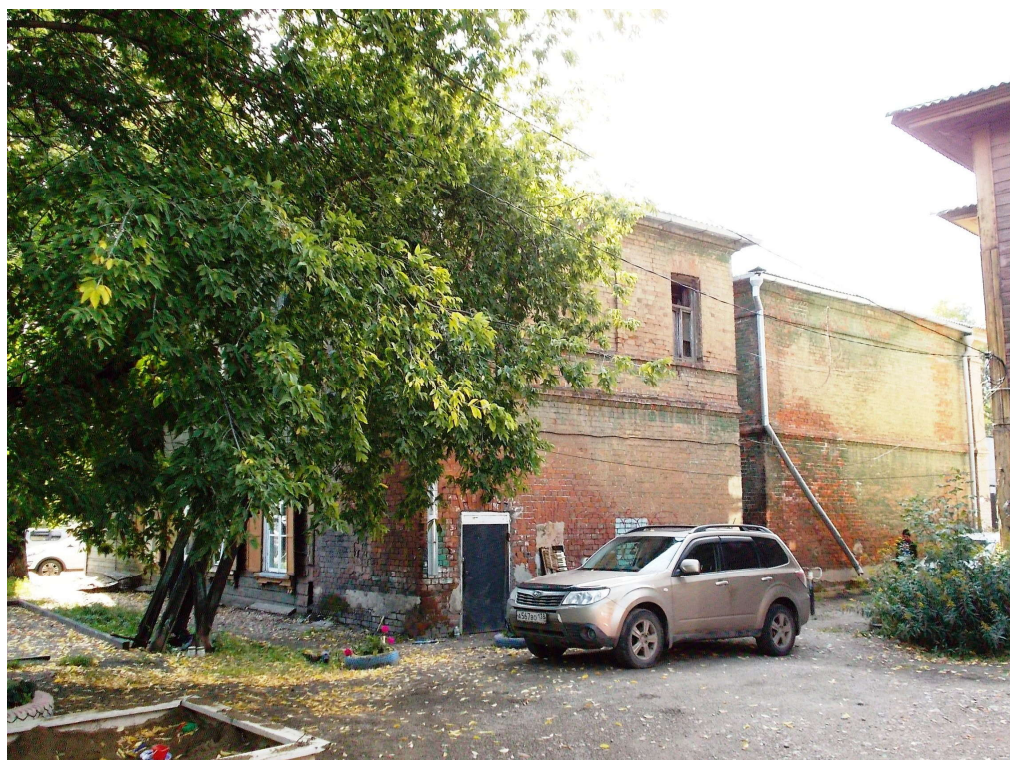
Общий вид фасадов по осям И и 1,2
